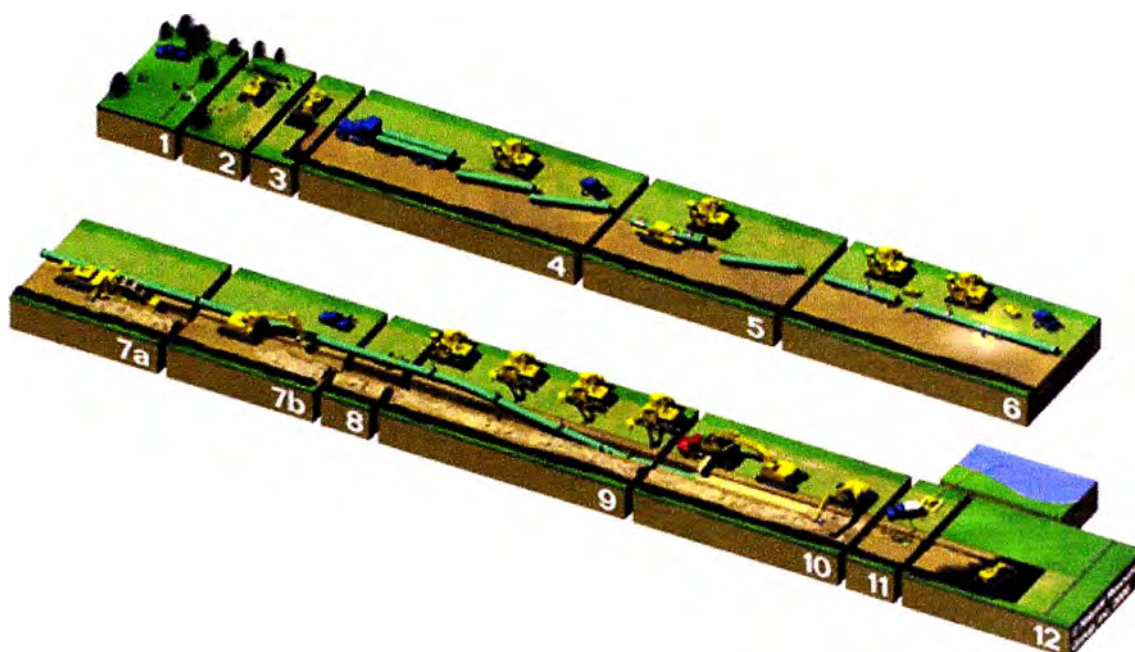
Secuencia de construcción de un ducto terrestre. 1) Trazado de detalle, 2) Abertura de pista, 3) Abertura de zanja, 4) Distribución de tubos, 5) Curvado de tubos, 6) Soldadura de tubos, 7a) Inspección de soldaduras, 7b) Recubrimiento de uniones soldadas, 8) Protección anticorrosiva, 9) Bajada de tubos, 10) Tapado de zanja, 11) Prueba hidrostática, 12) Protección de pista. Adaptado de Enbridge™, [10].
